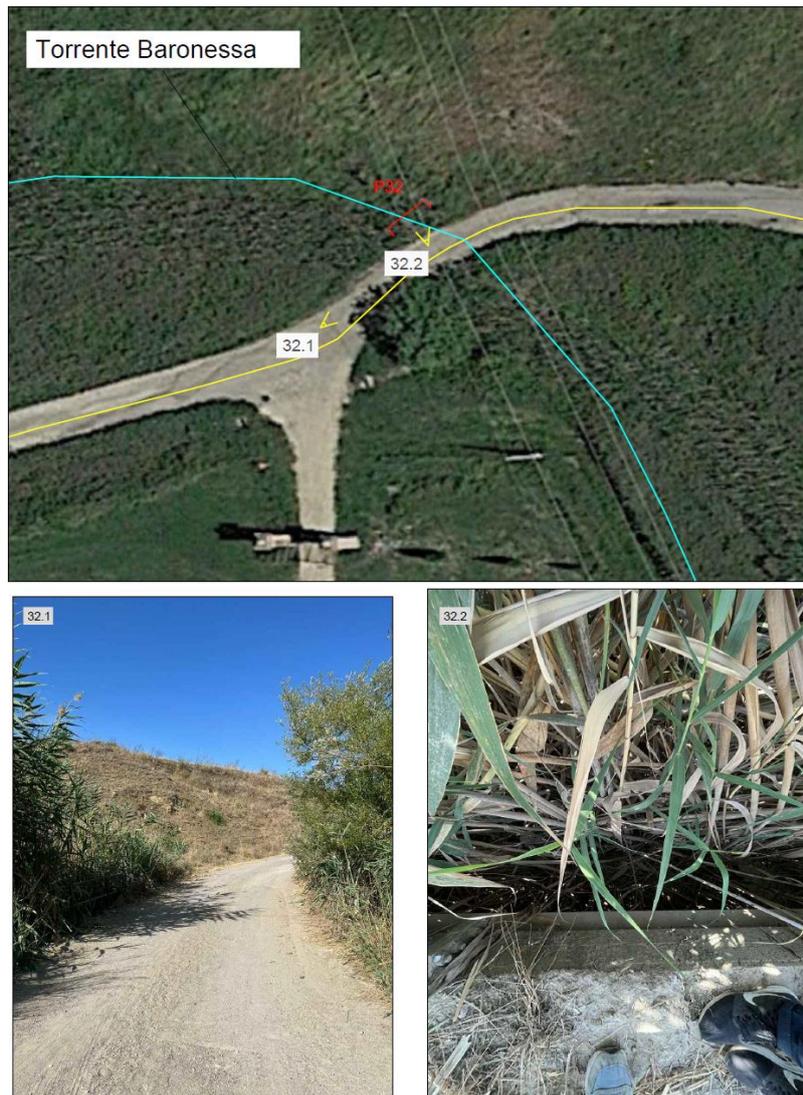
Attraversamento n.32 - Stralcio su ortofoto e foto
